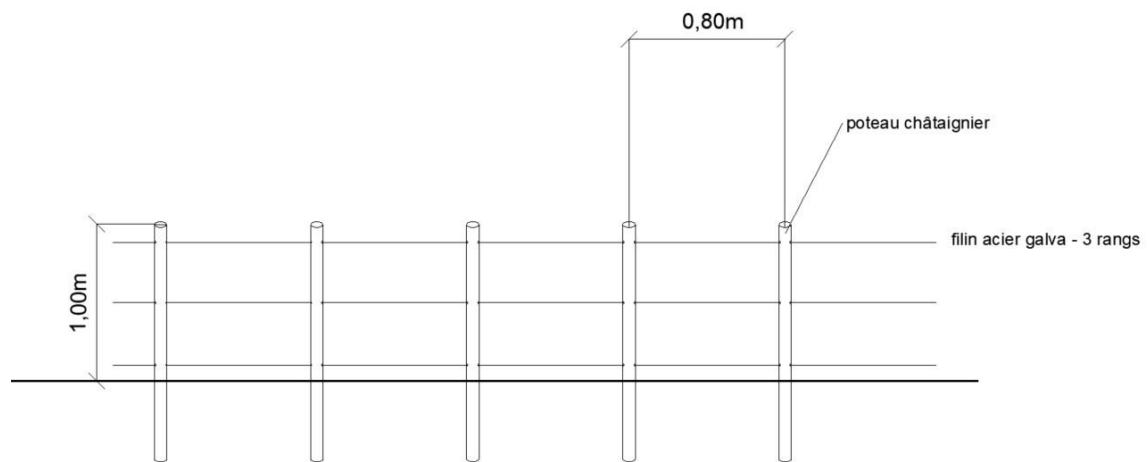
poteau châtaignier + filin 3 rangs (haut de plage)
